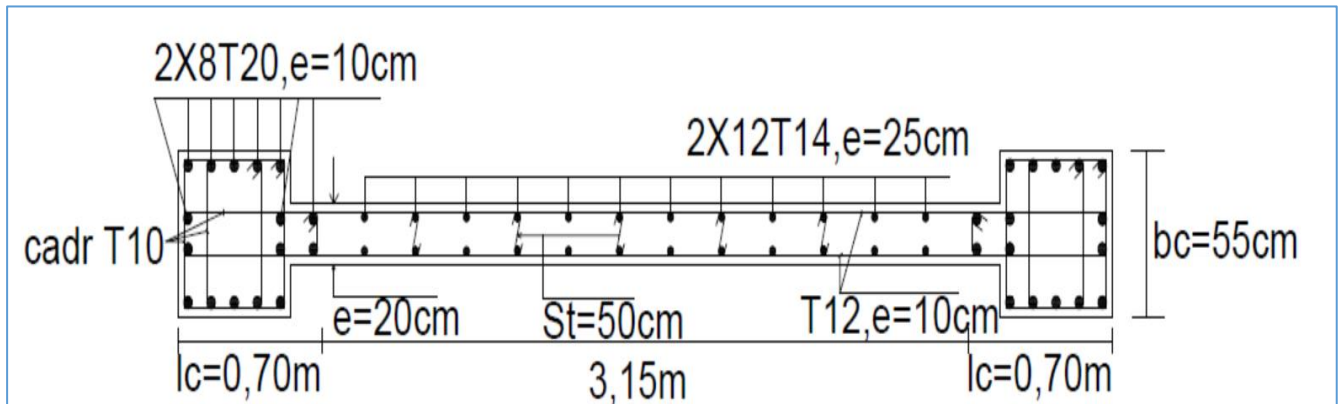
La coupe de ferrailage des voiles sens y épaisseur 20cm.
